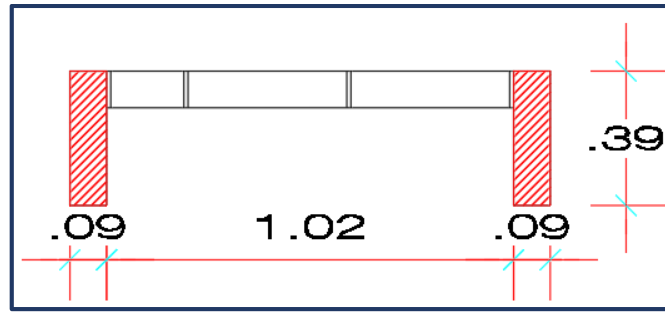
Esquema del Tipo 2 – Vista Planta.
